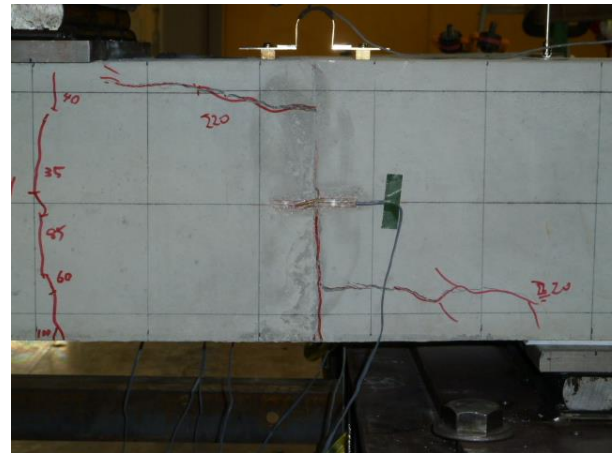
試験体 2-1 鉛直変位 3.0 mm 時点破壊状況
